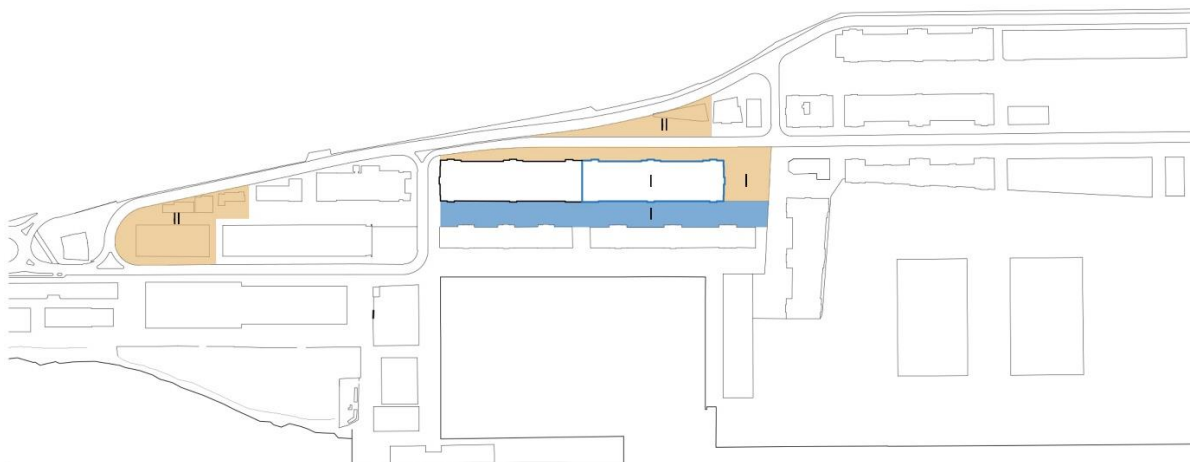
Schema planimetrico con l'individuazione dei due lotti di intervento (Lotti I e II).
